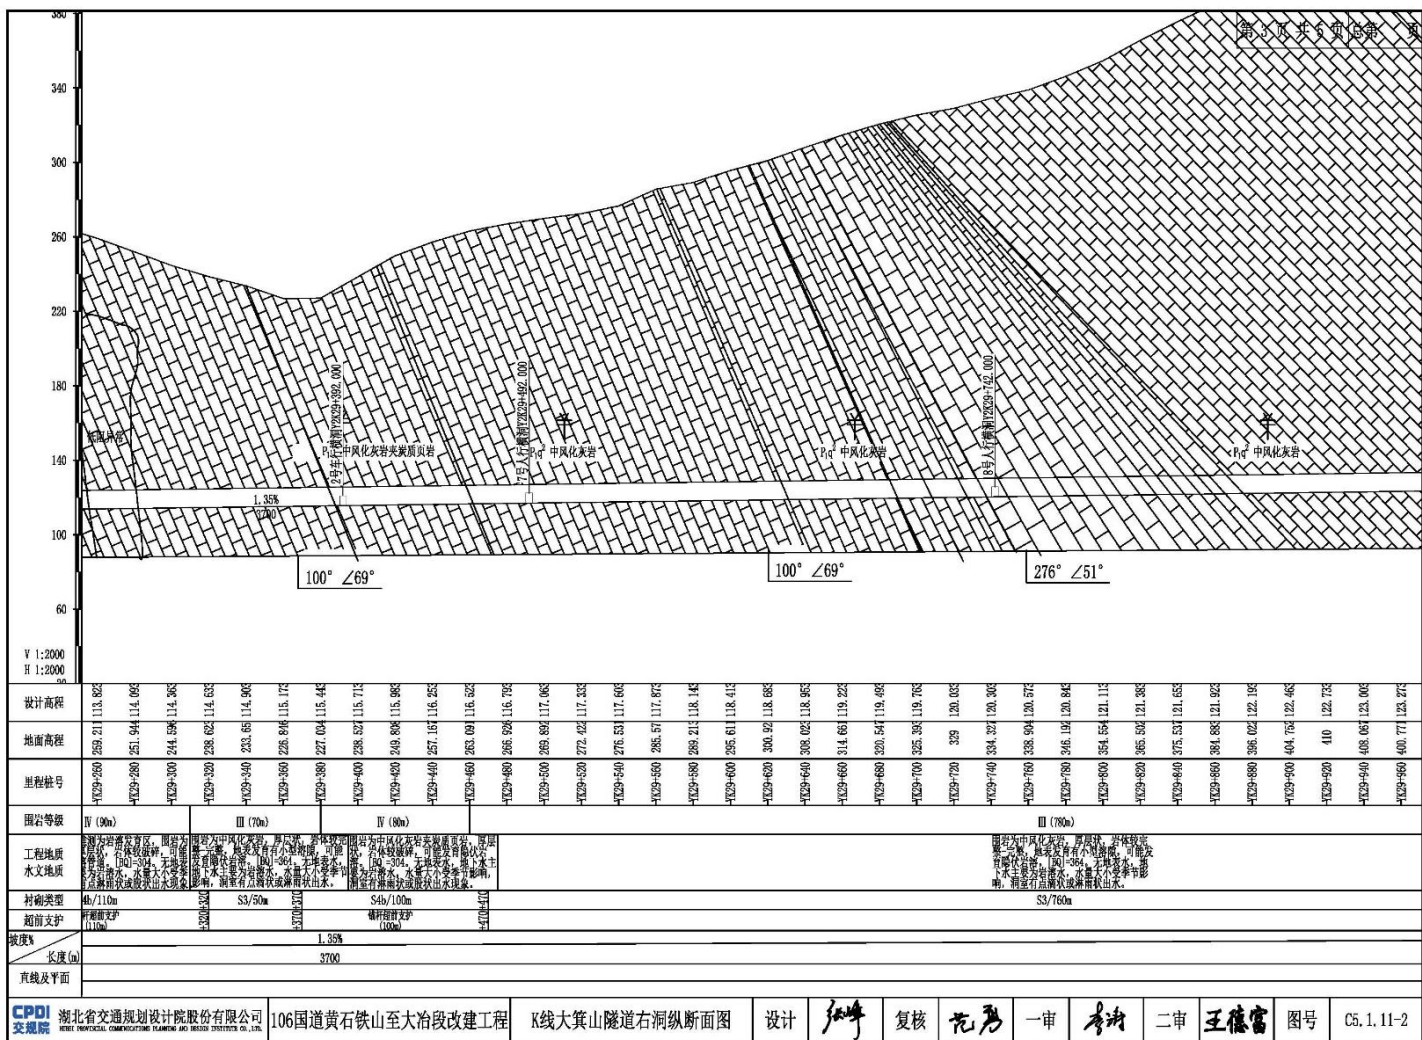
大箕山隧道右洞纵断面图 (三)
